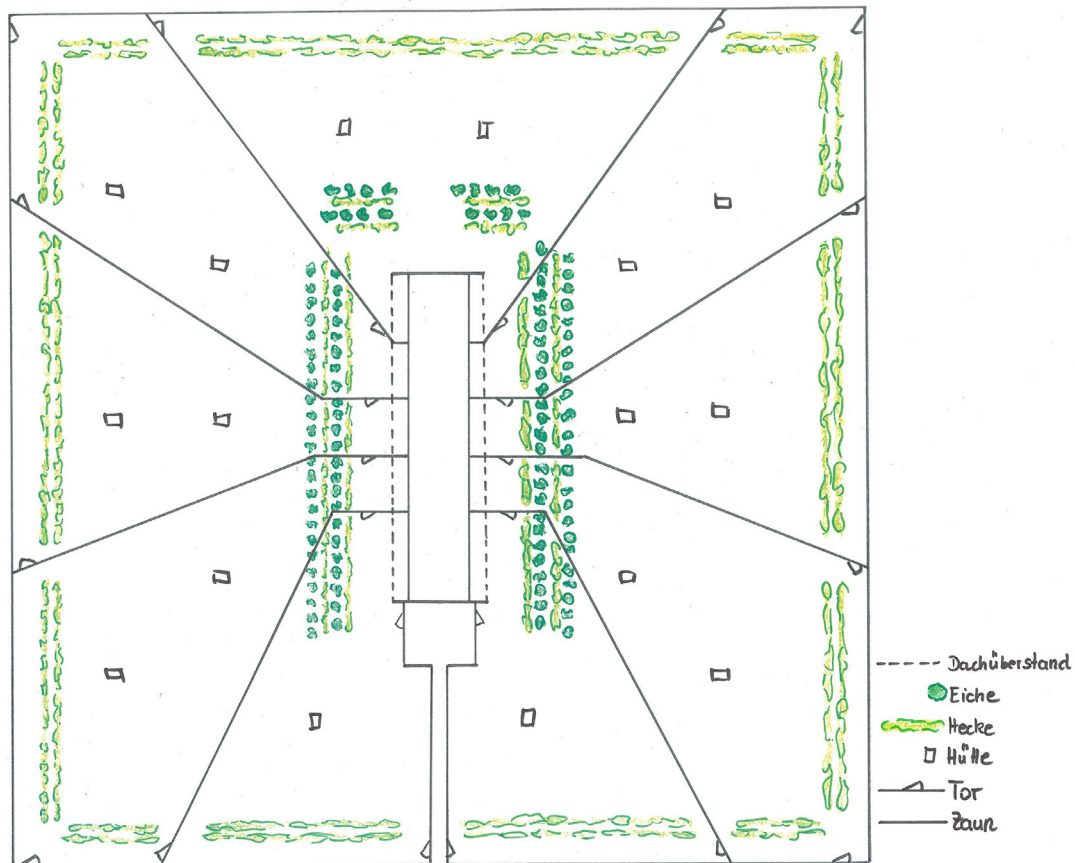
Skizze: Grundriss – Planungsbeispiel 2
